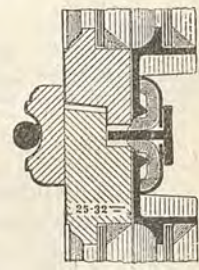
Sistema Spengler per finestre con pilastro centrale fisso.
